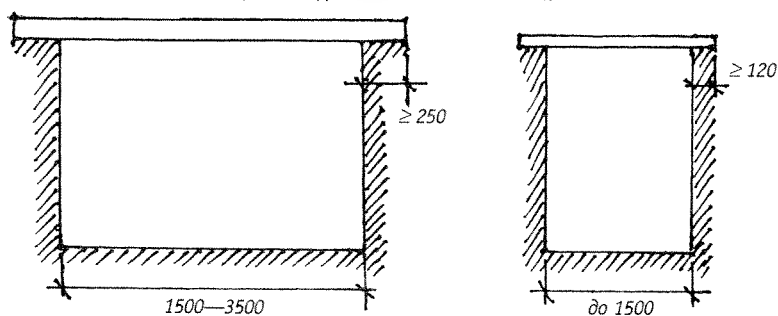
Устройство проемов с помощью сборных железобетонных перемычек
